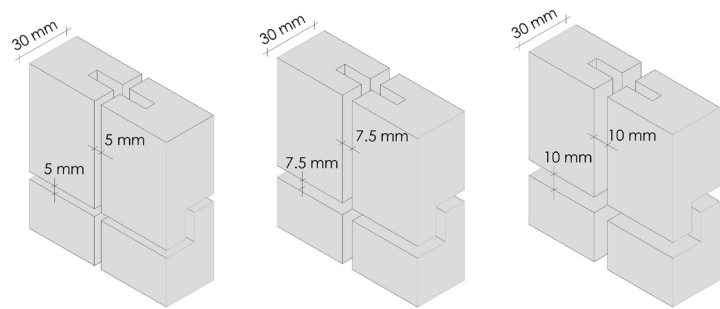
Esquema de junta vertical acanalada y horizontal rebajada para las amplitudes de 5, 7.5 y 10 mm.
